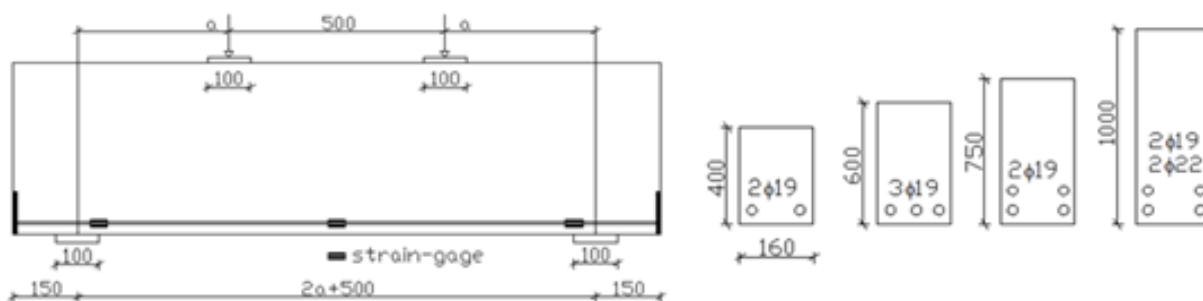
Detalhes da geometria da viga e arranjo das armaduras (YANG, 2010).
